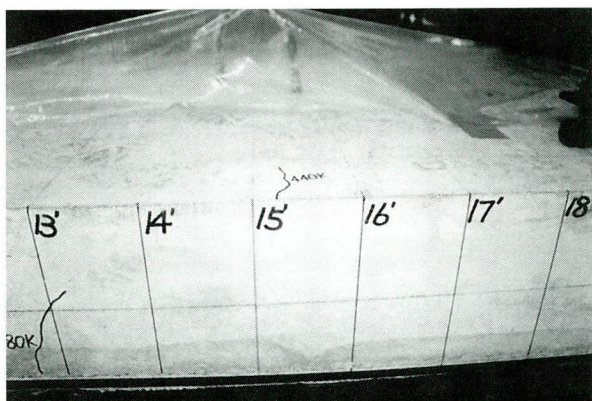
コンクリート上面と側面のひび割れ状況
